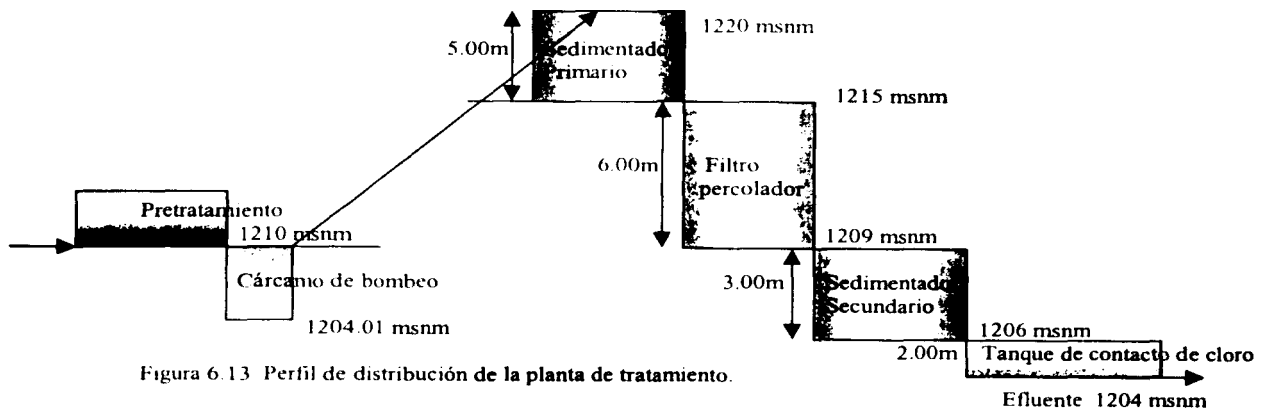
Perfil de distribución de la planta de tratamiento.
